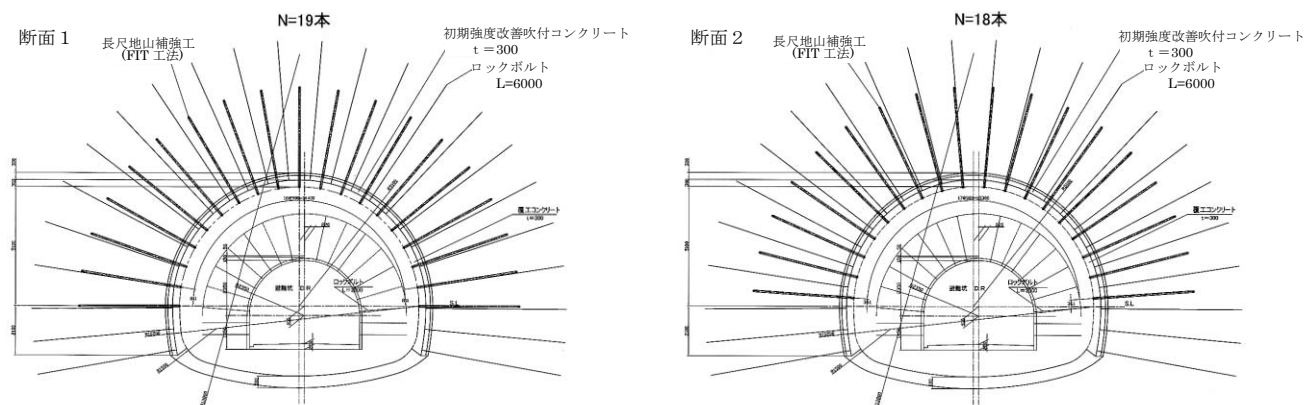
長尺地山補強工（FIT 工法）横断方向配置図
